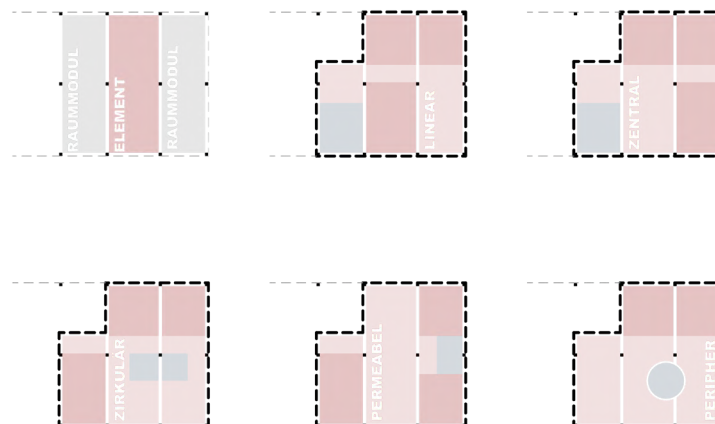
Skelettstruktur als Grundlage für Grundriss- und Nutzungsflexibilität von Gebäuden
